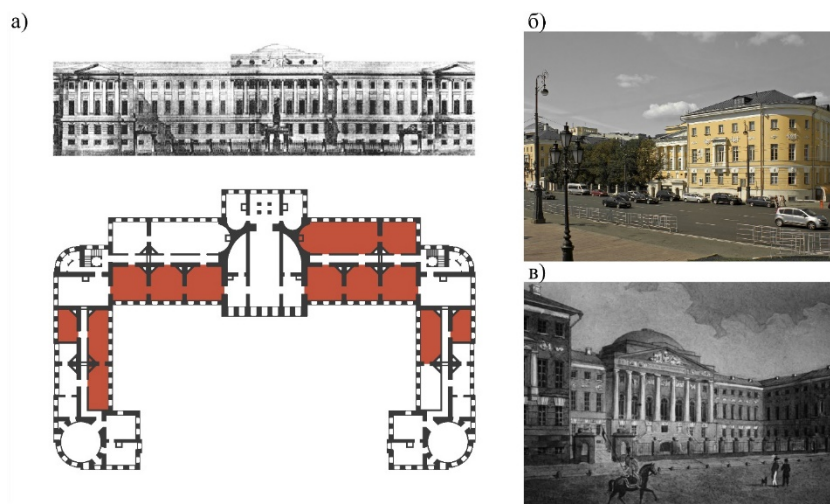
Московский университет. Москва 1794 г. (а – фасад и план 2-ого этажа, б – фасад, в – фасад в 1892 г. на основе акварели А.Я. Афанасьева).
